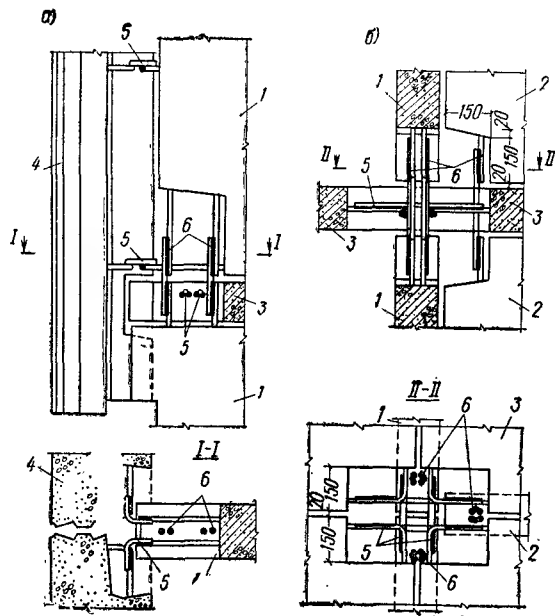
Сопряжение панелей несущего остова здания повышенной этажности с непрерывным армированием
